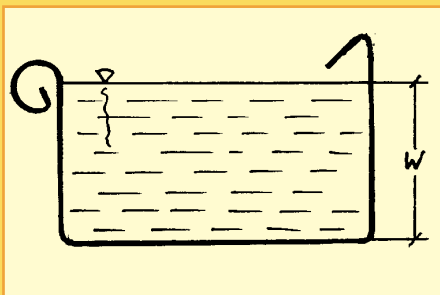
Planmäßige Wassertiefe einer Dachrinne W
